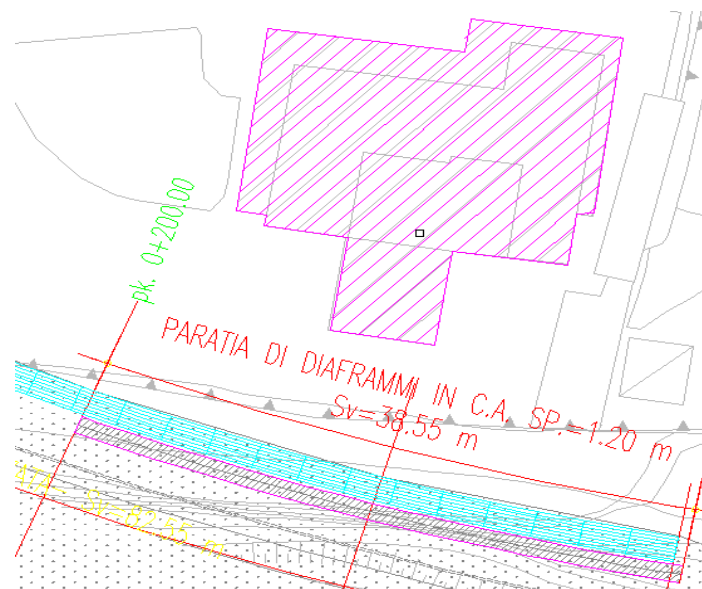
Planimetria Paratia Provvisoria- Asse 1-3
